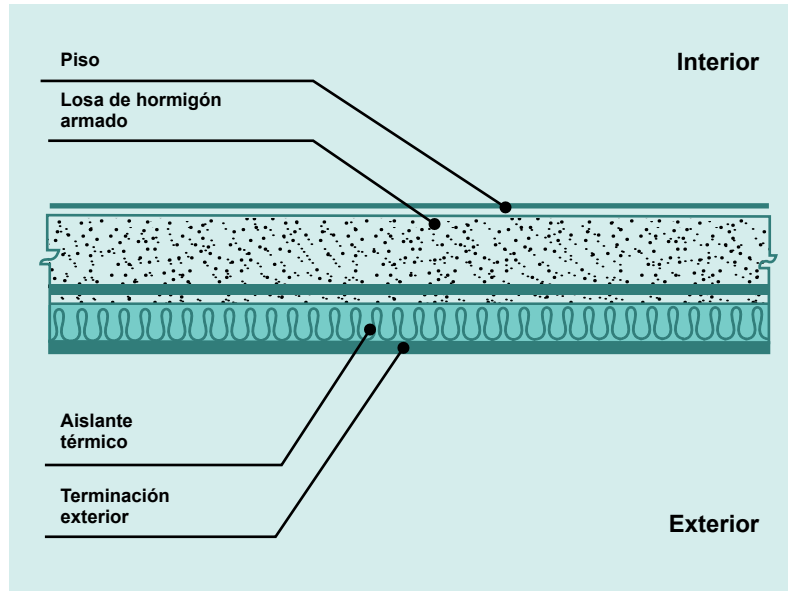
Aislación térmica del piso por el exterior de la vivienda, con losa de hormigón armado
